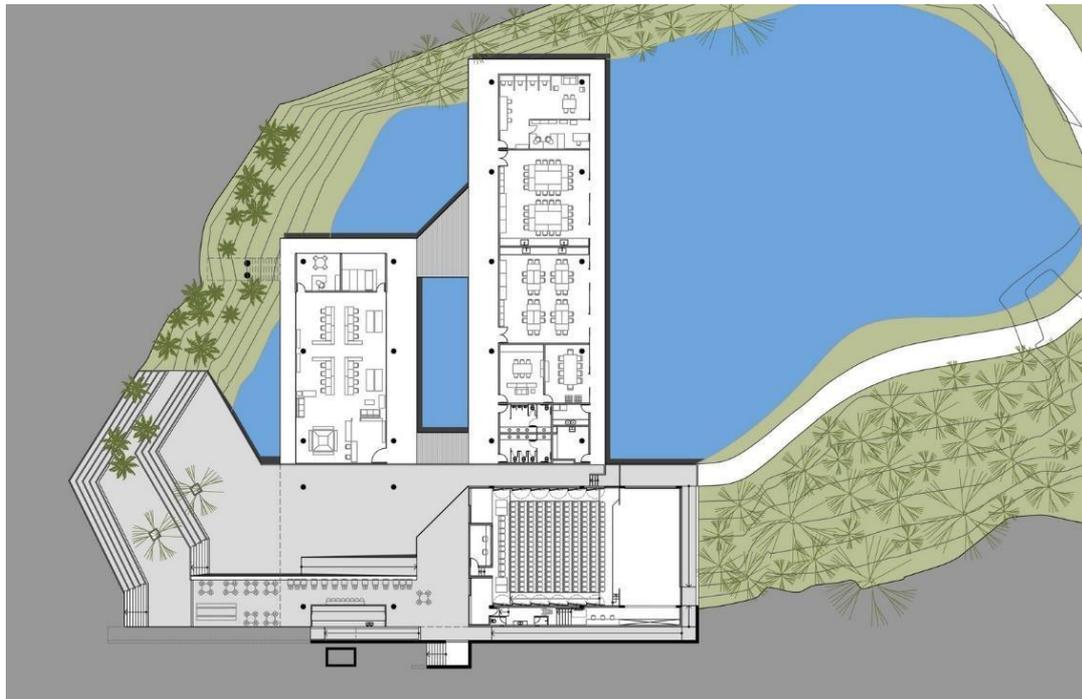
Planta baixa Centro Educacional Burle Marx.
